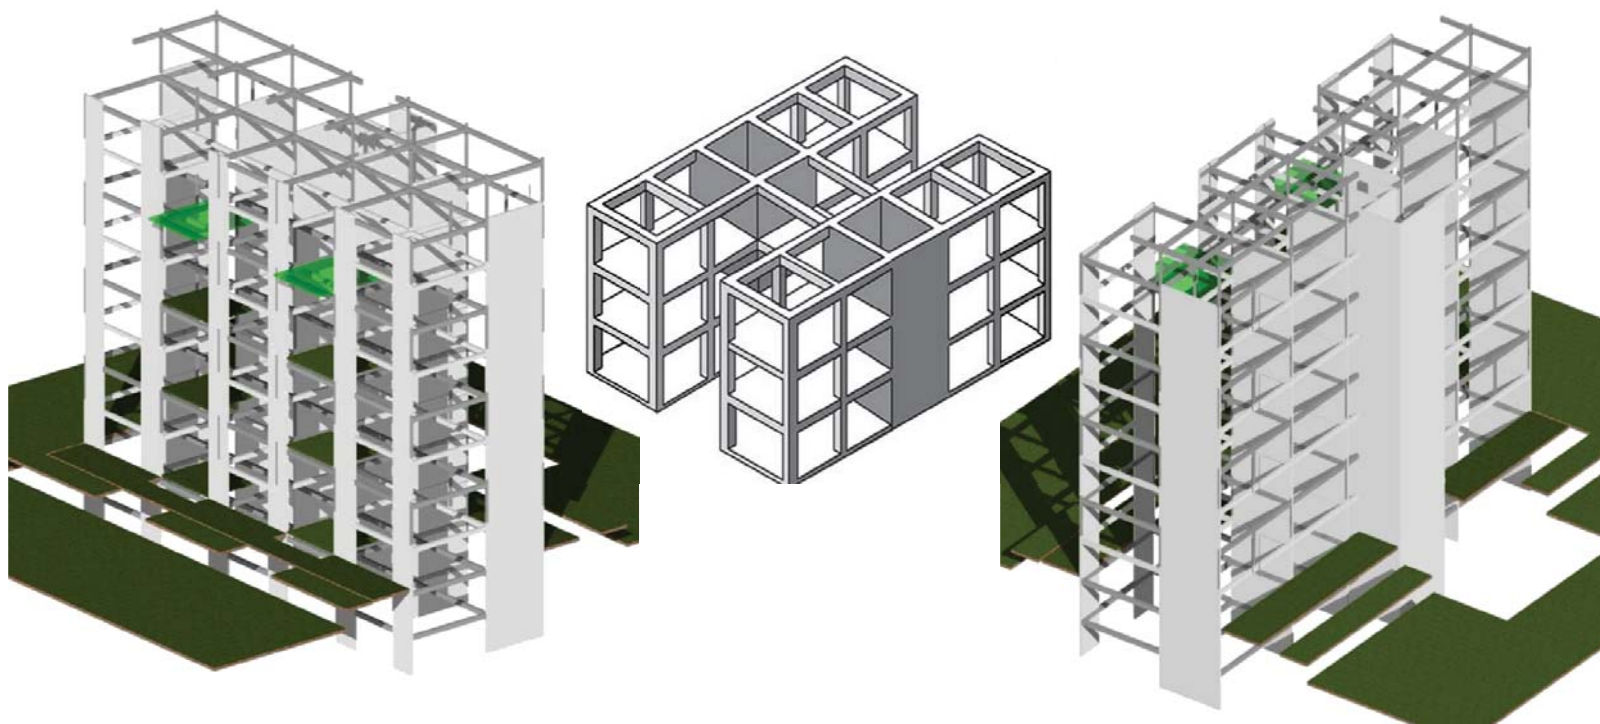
Sistema estructural de columnas y placas en los edificios de vivienda.
